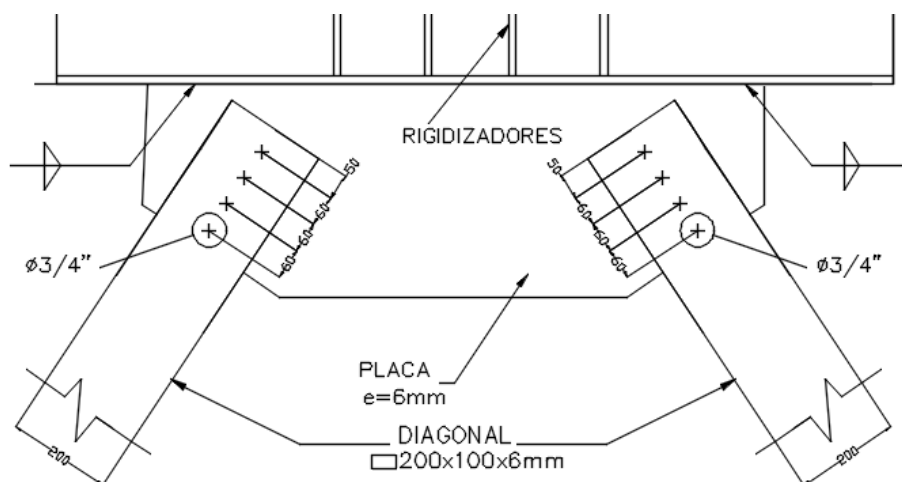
Detalle de disposición de pernos para conexión tipo 2
